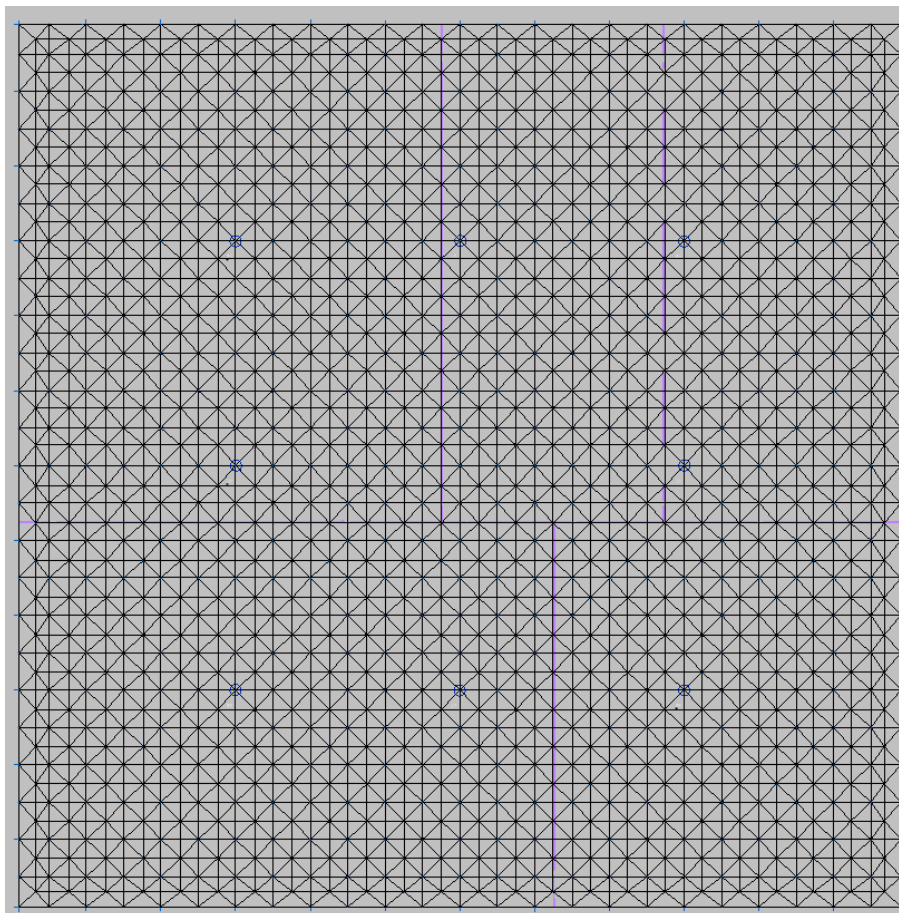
Planta de cubierta con tramos de puertas móviles.
